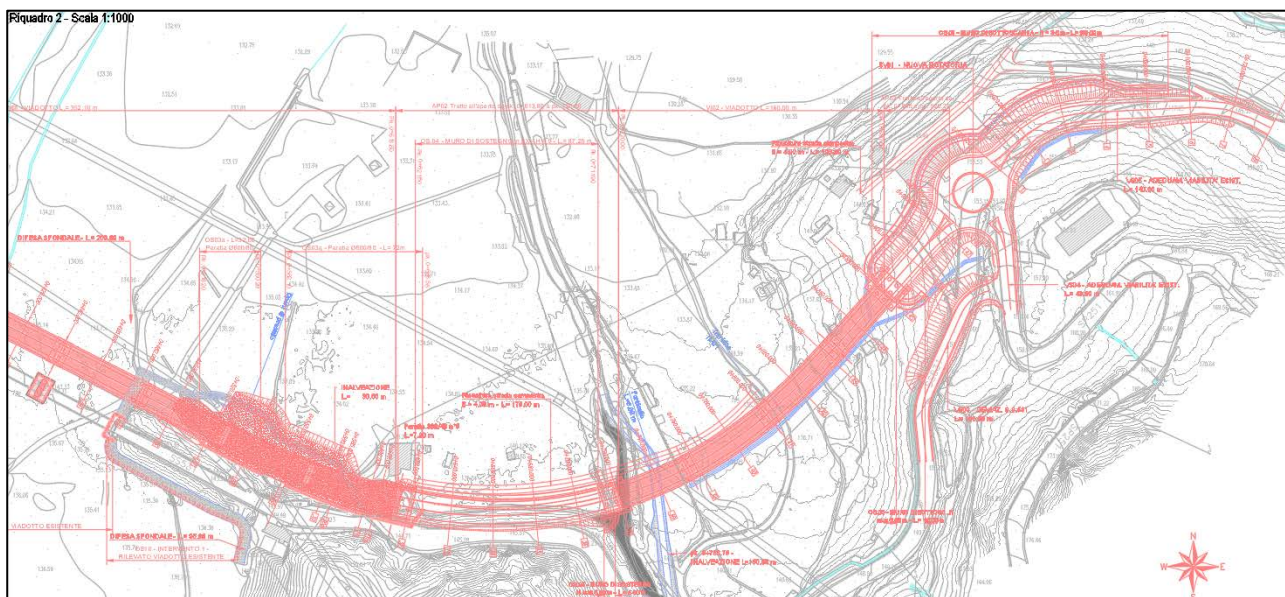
Planimetria di progetto da pk 0+400 a pk 0+926
